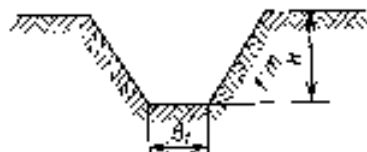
Сечение траншеи для раздельной укладки труб.
